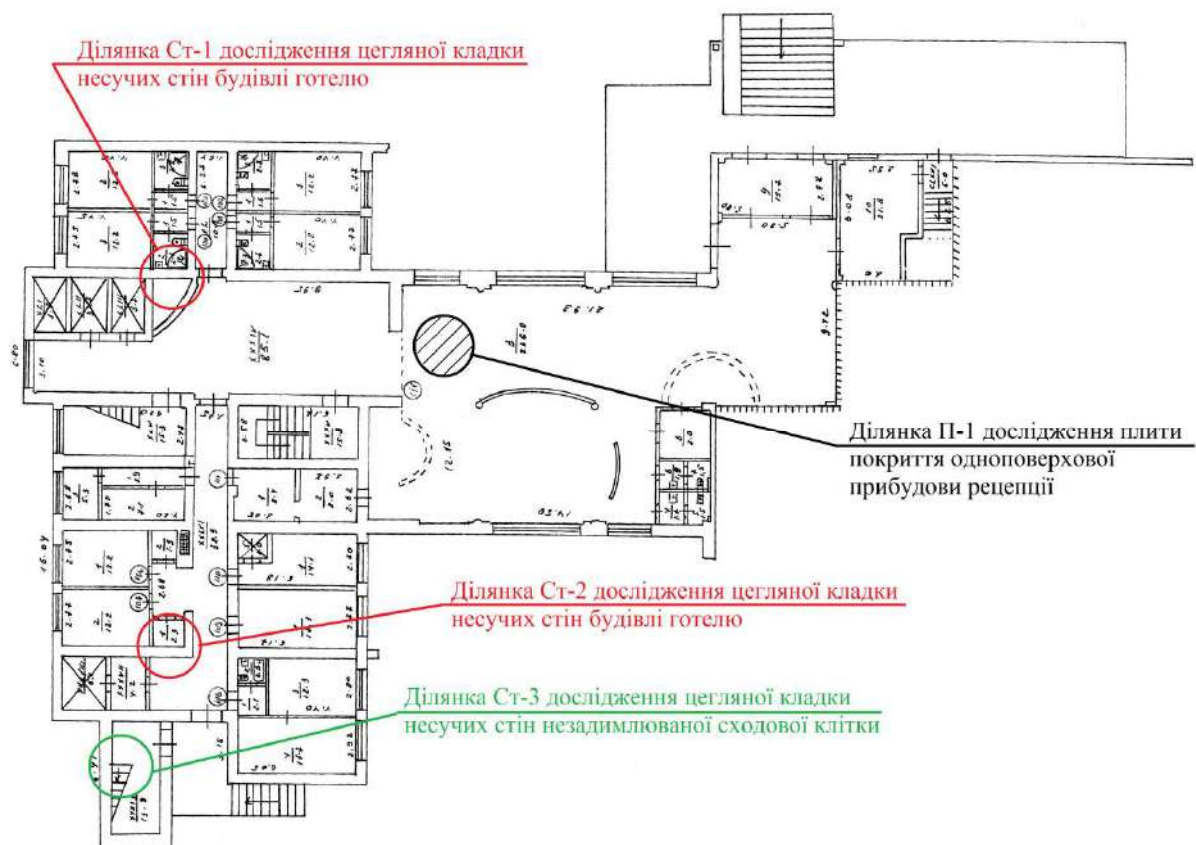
Схема розташування ділянок інструментального обстеження несучих конструкцій 1-го поверху будівлі готелю
